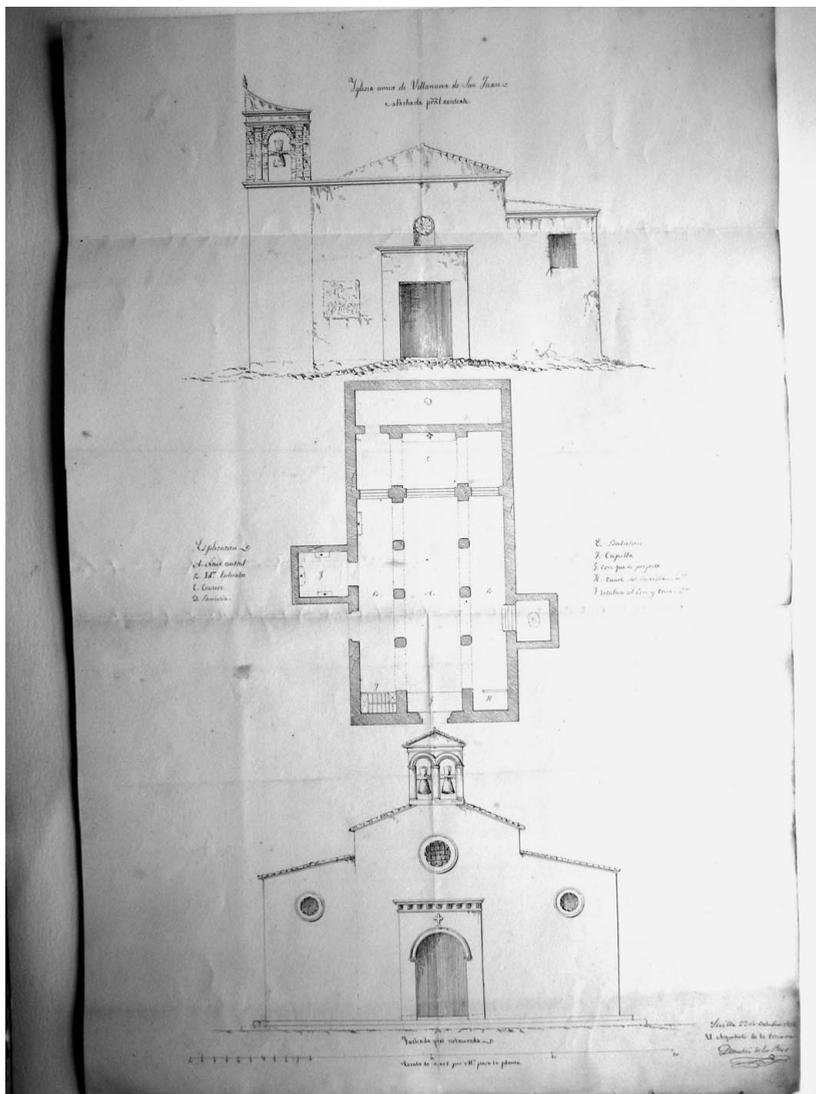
Plano y alzados de la parroquia de Villanueva de San Juan. Demetrio de los Ríos. 1856. Archivo General del Arzobispado de Sevilla. Sección Administración. Serie Casas parroquiales y reconstrucciones de templos, legajo 12447.
